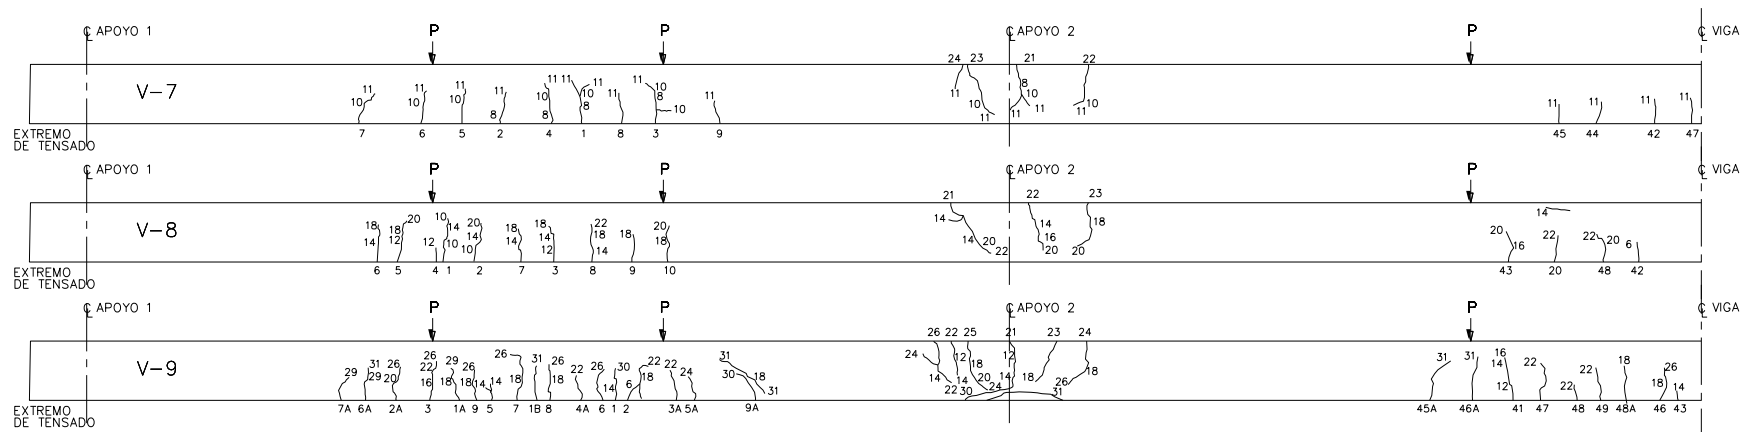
Localización típica de grietas en vigas V-7, V-8 y V-9 (300 x 150 mm). Media elevación lado izquierdo.
